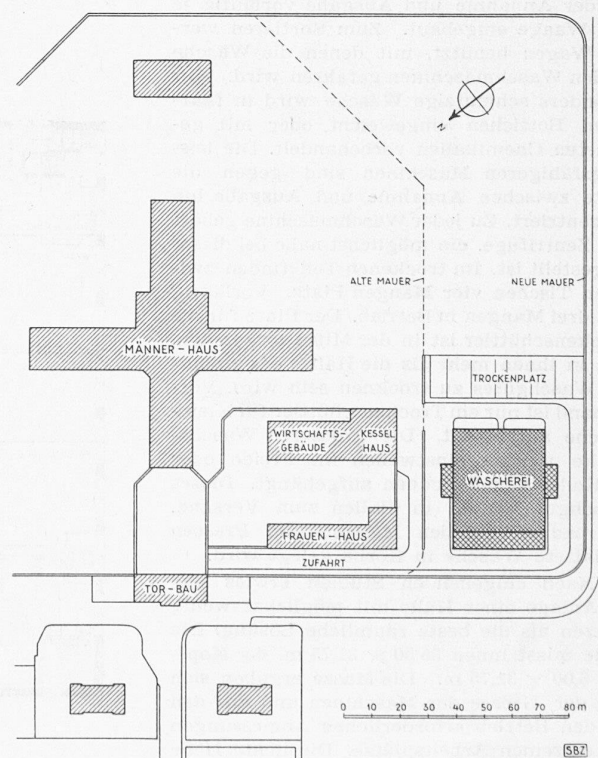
Lageplan mit Areal der Strafanstalt Regensdorf
